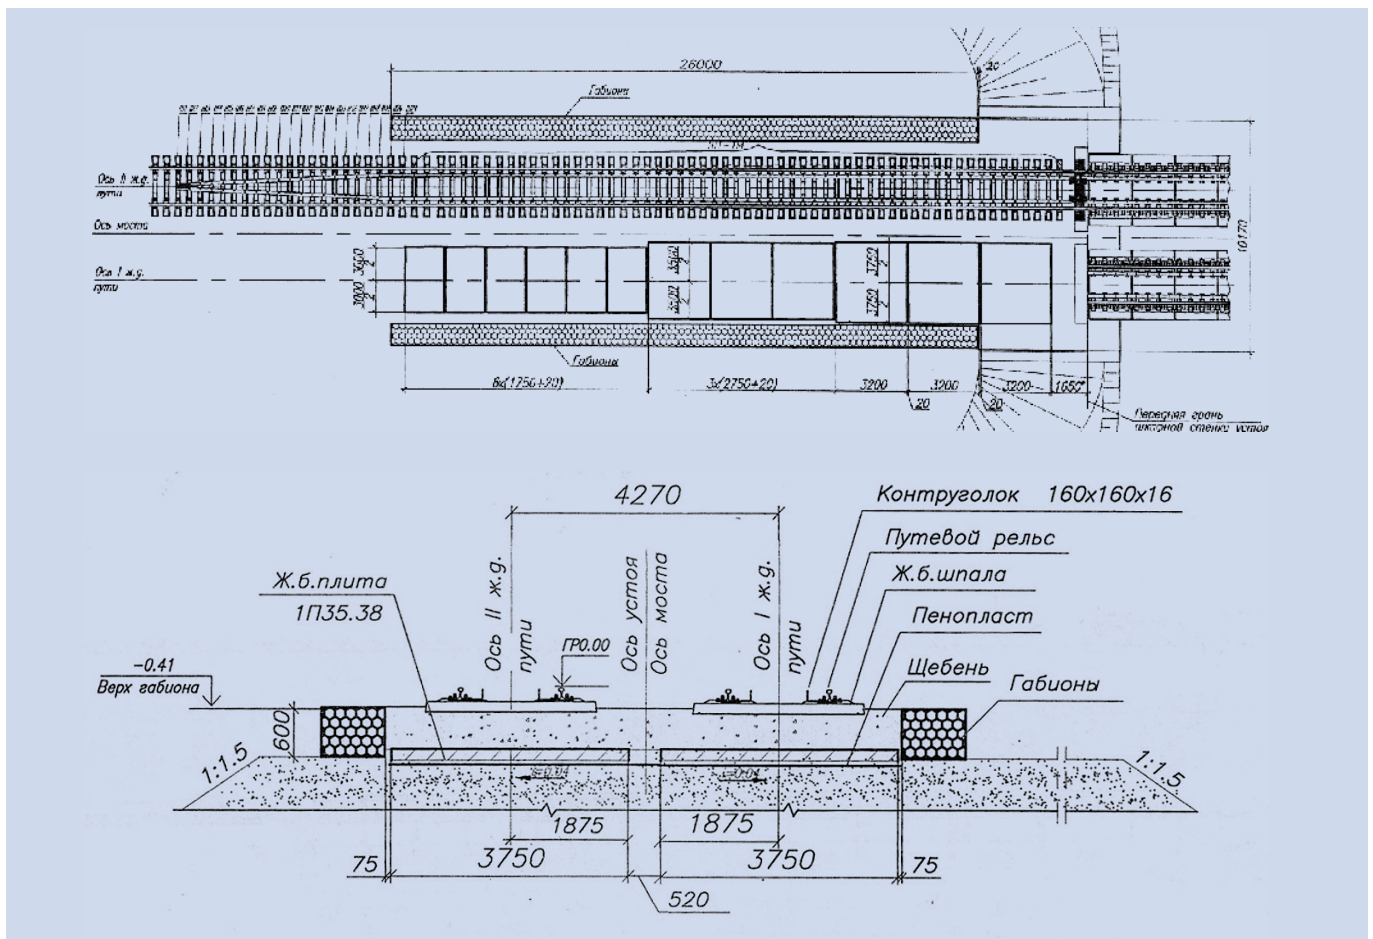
Конструкция переменной жесткости с железобетонными плитами
